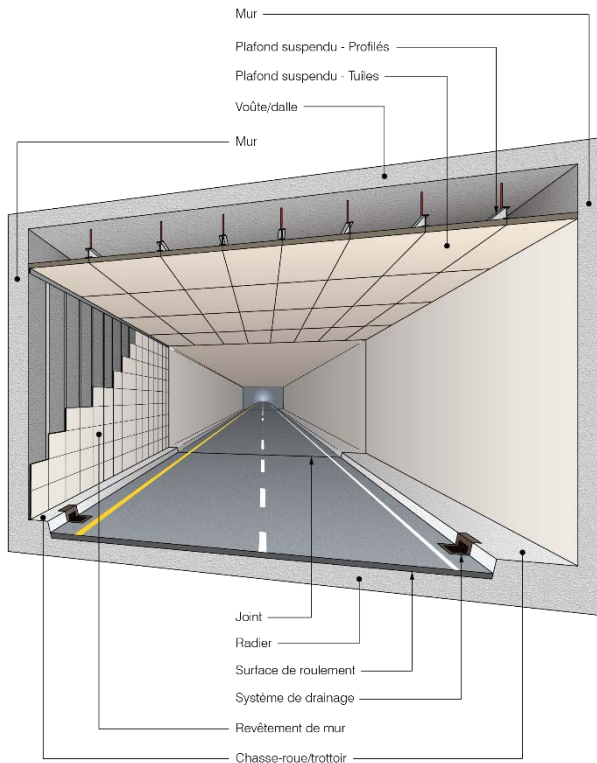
Sectionnement d'un tunnel avec paralumes
